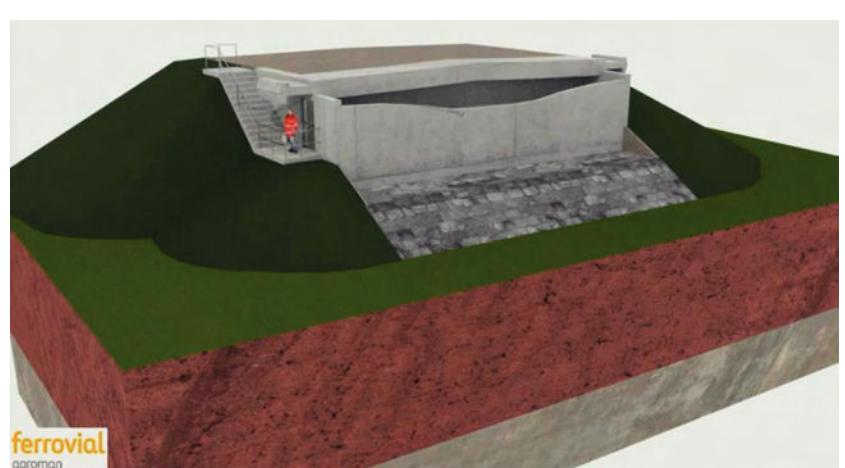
Modelo 3D de estribo con acceso a galería visitable.
